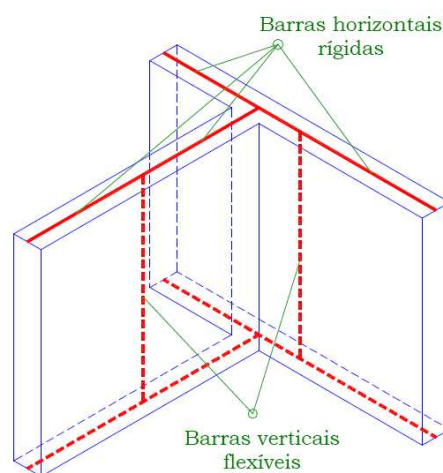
Detalhe da modelagem das paredes de contraventamento (NASCIMENTO NETO, 1999).
